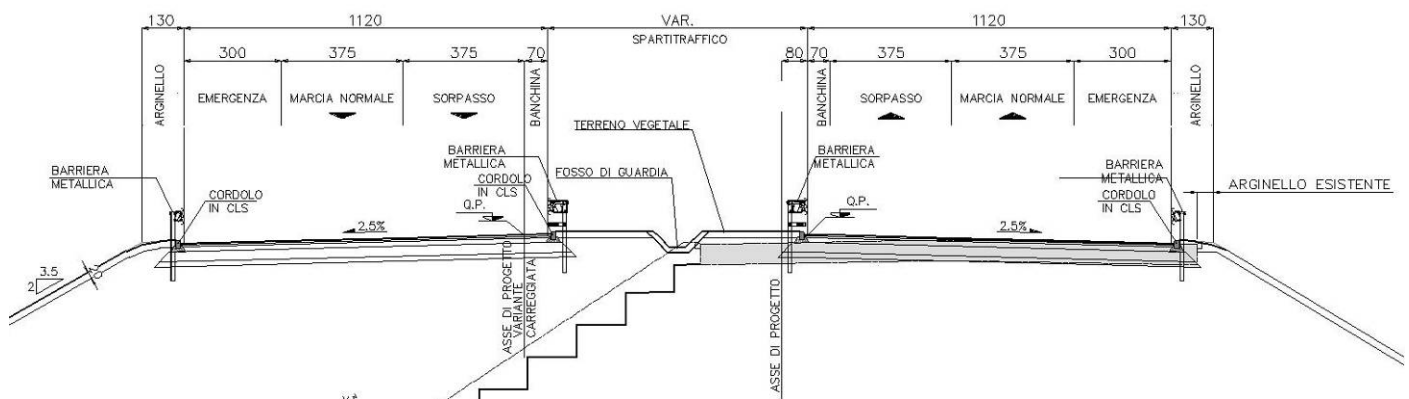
Sezione tipo di progetto con Carr. Nord in variante (adeguamento SS1 Aurelia)
